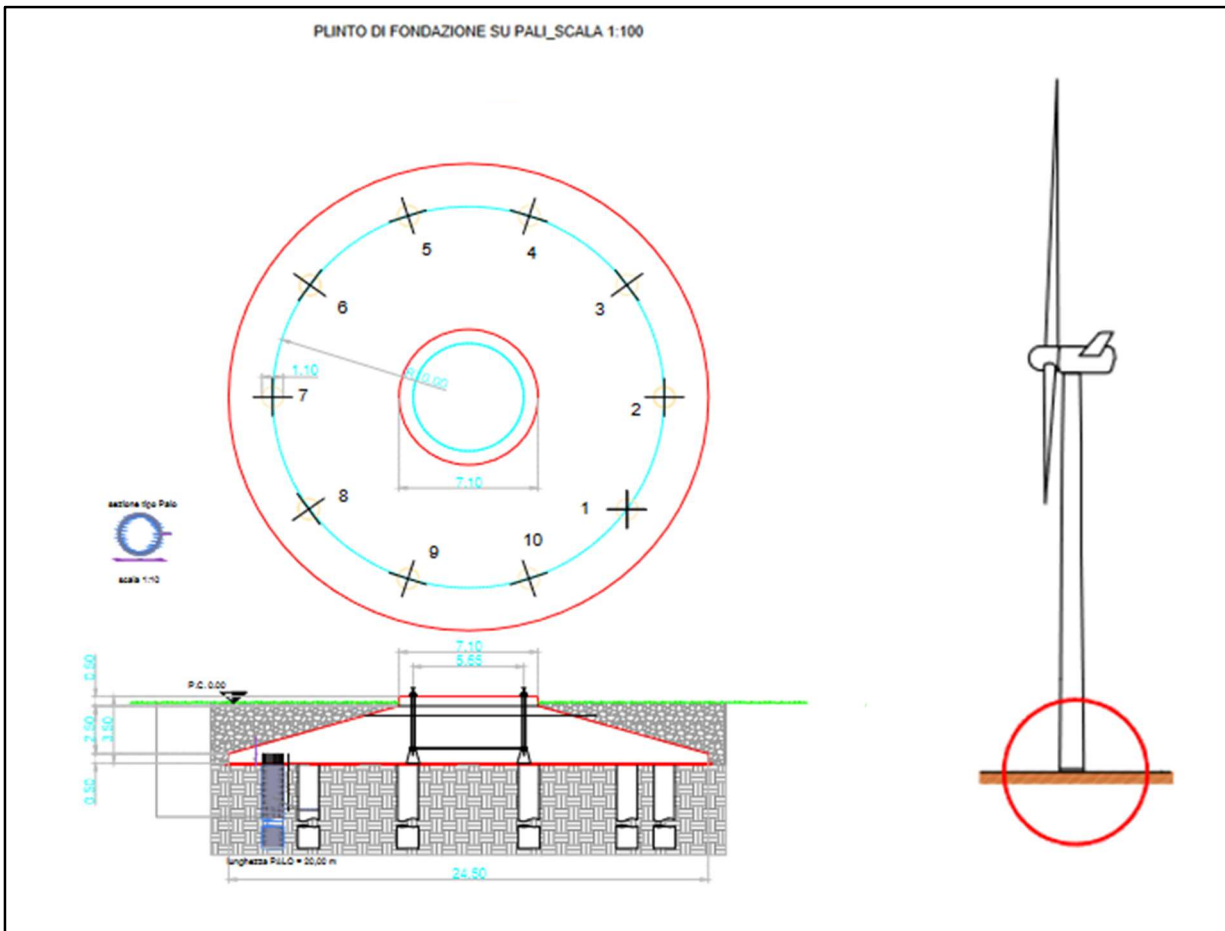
Dettaglio pianta e sezione fondazione
